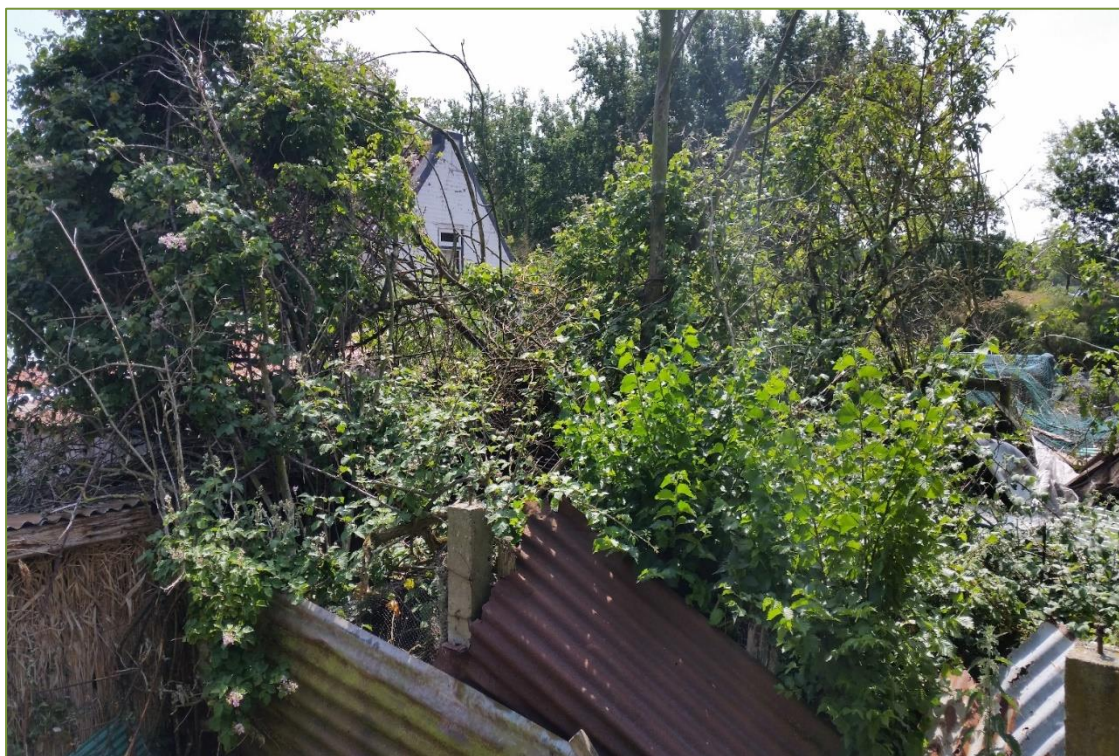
situatie voor sanering. Bijgebouwen zijn overwoekerd door bomen en struiken
